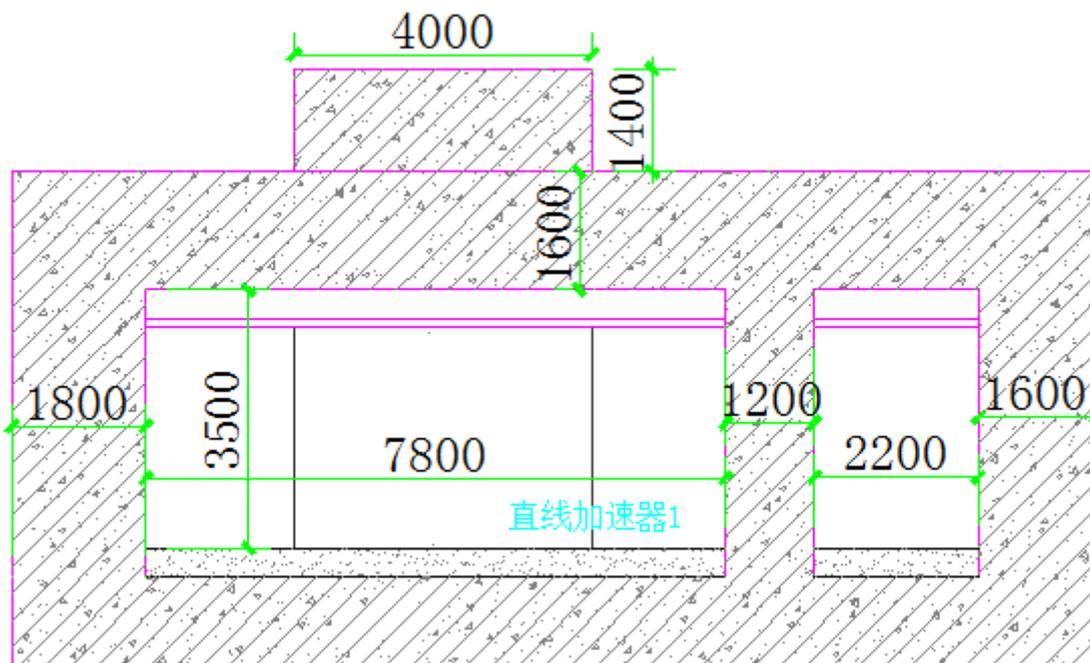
直线加速器机房 1 (2-2) 剖面图 1:100
